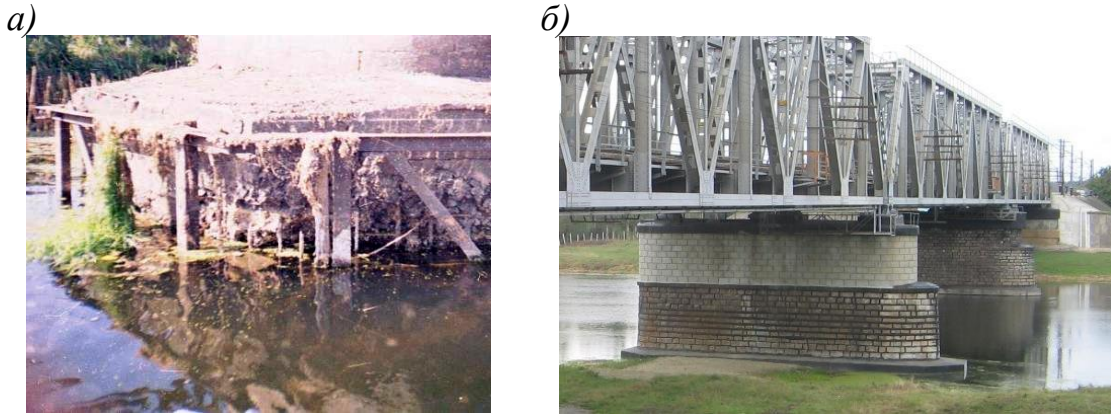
Опора № 3 моста через р. Сів. Донець на 284 км ділянки Основа – Букине Південної залізниці: а) пошкодження залізобетонного пояса біля обрізу фундаменту; б) посилений і захищений від електрокорозії пояс і опора за допомогою сталобетонної обійми, що заземлена в дно річки
